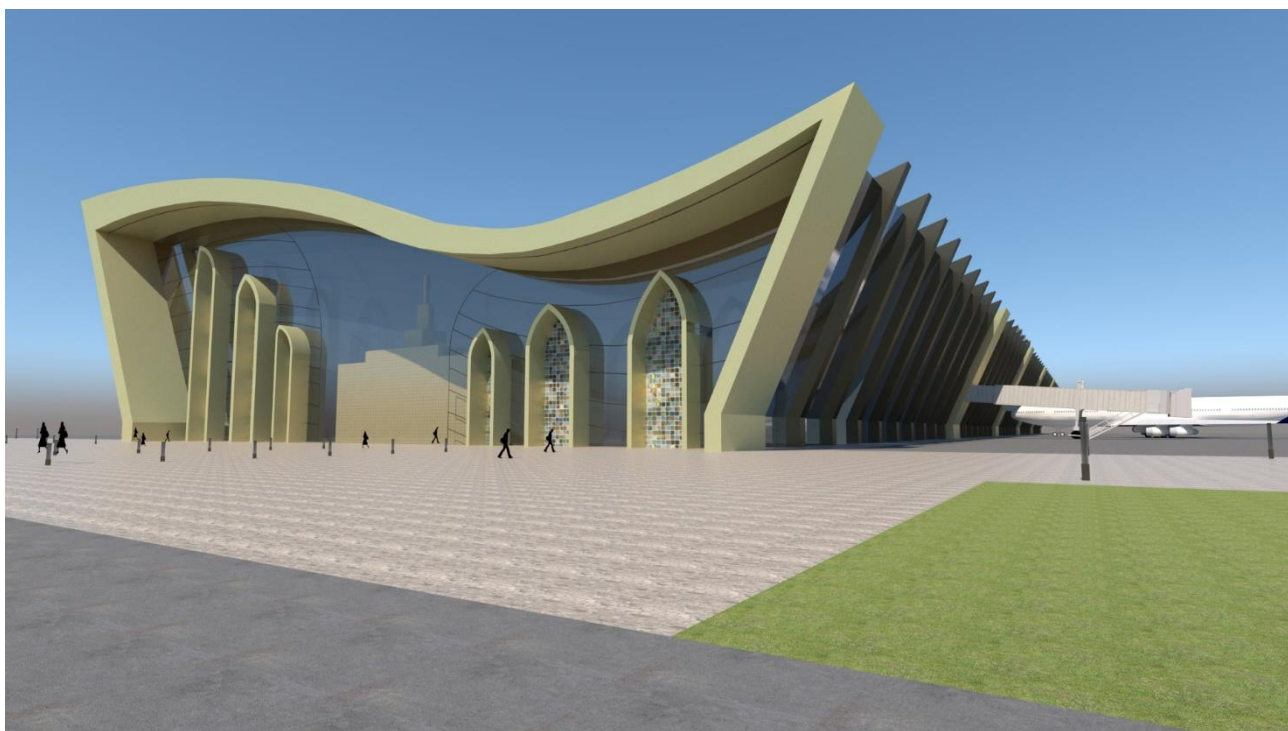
Общий вид нового терминала аэропорта (чертеж автора)
